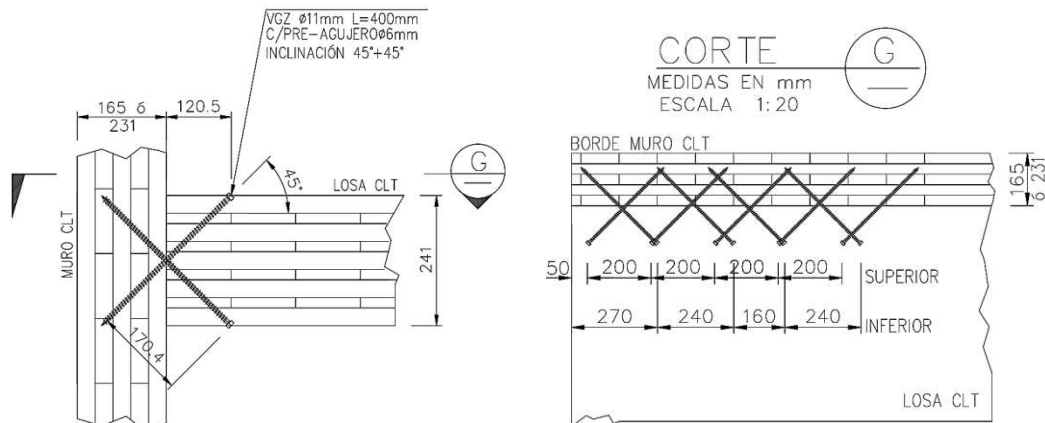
Detalle conexión muro-losa, vista en elevación y planta (mm)
